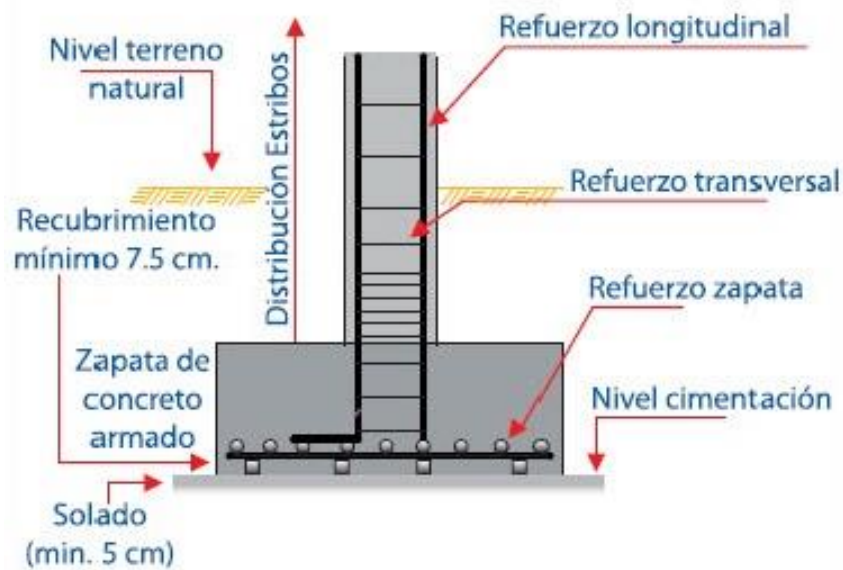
Armado de zapatas en el sobre cimiento, fuente: aceros Arequipa
